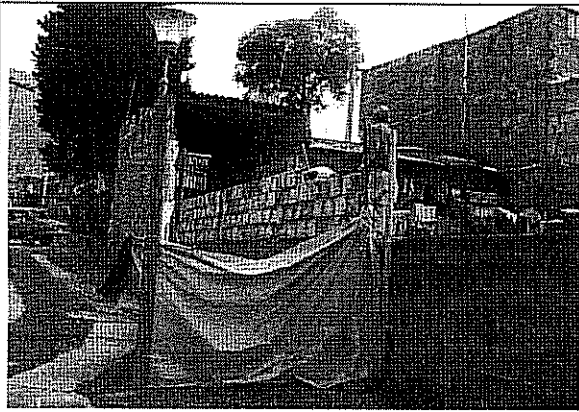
Vista de los muros de la zona posterior de la edificación, cubierta en buen estado.
